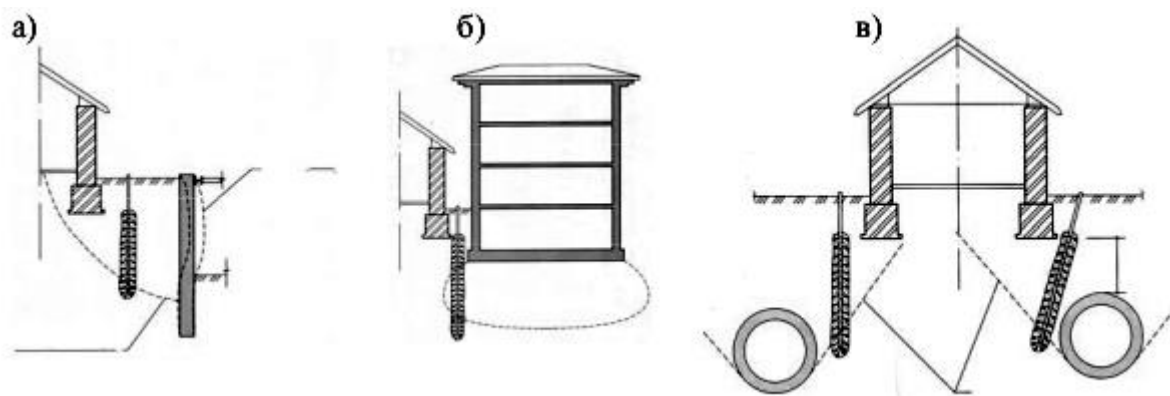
Захист фундаментів існуючої будівлі за допомогою геотехнічного бар'єра.
